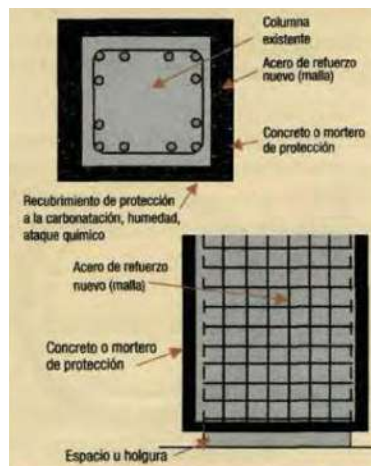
Encamisado con malla de acero y concreto o mortero de protección.
